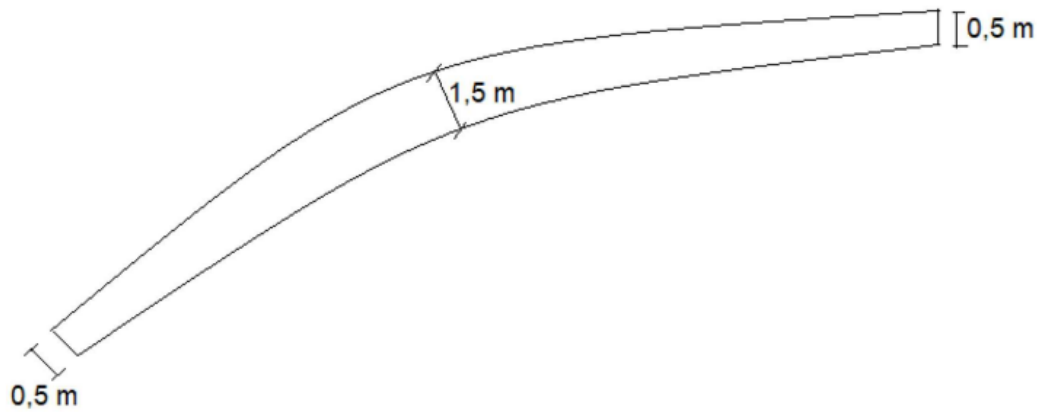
Predimensionamiento del canto de la pasarela (Fuente propia)
